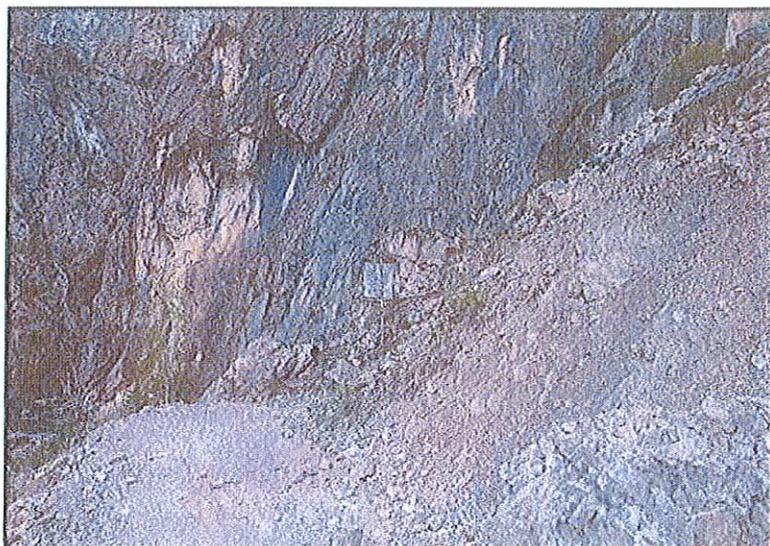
Implantation du futur bâtiment (piste d'accès)
